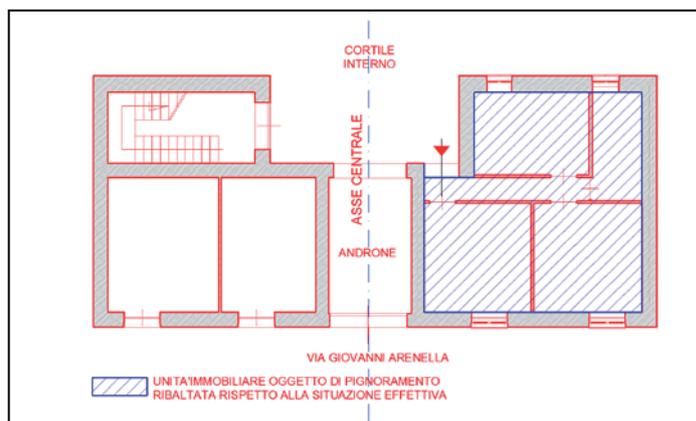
Planimetria rappresentata nei grafici di progetto di cui all'Autorizzazione
